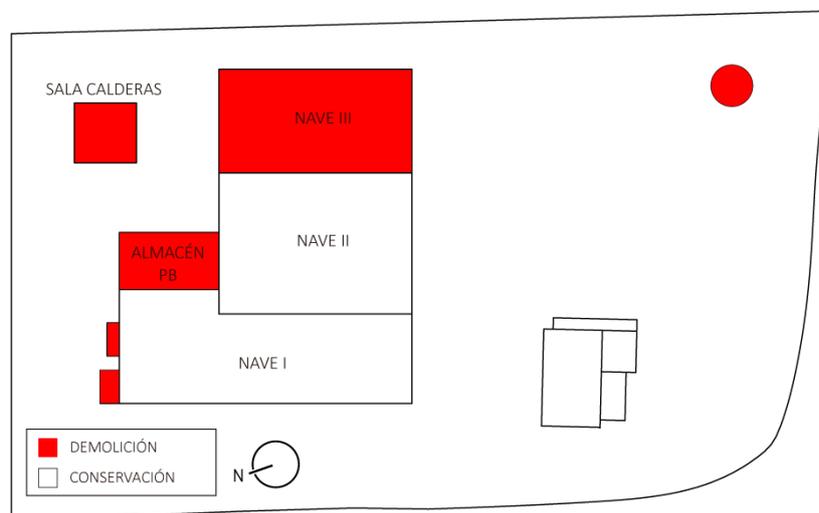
Planta de parcela con las estructuras a demoler y conservar (sombreado rojo). Fuente: elaboración propia.
